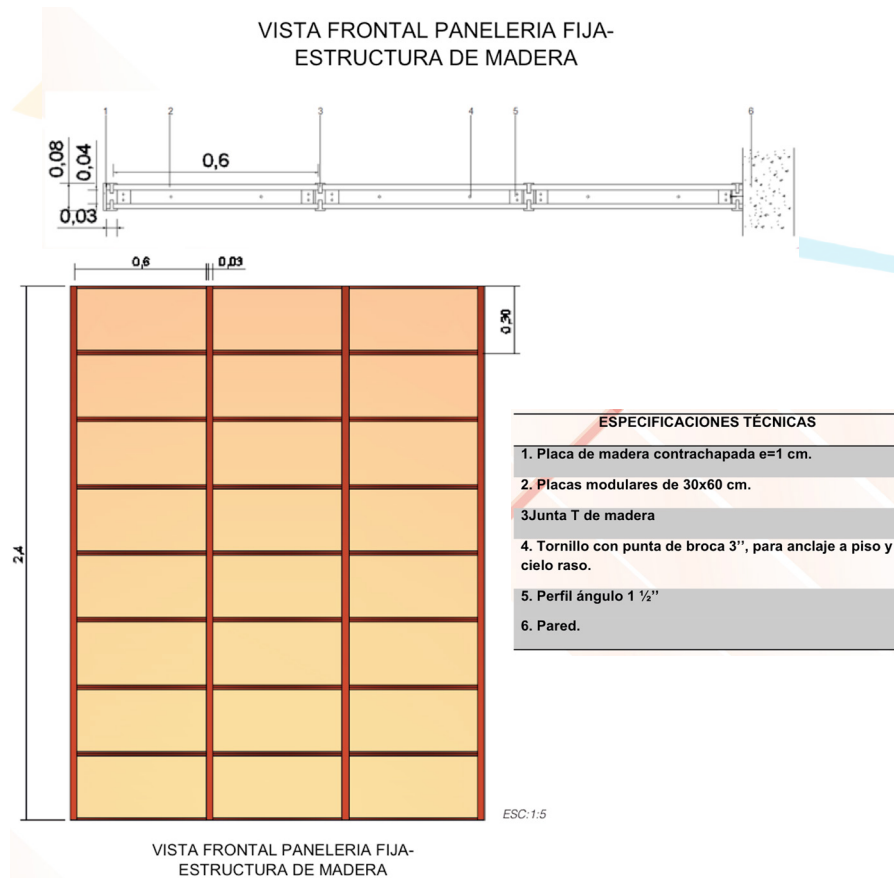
Detalle constructivo. Danilo Barrera 2014.
